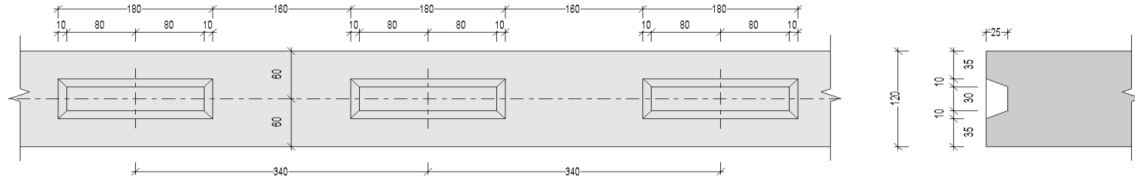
Junta indentada na interface lateral entre painéis de laje CREE.
